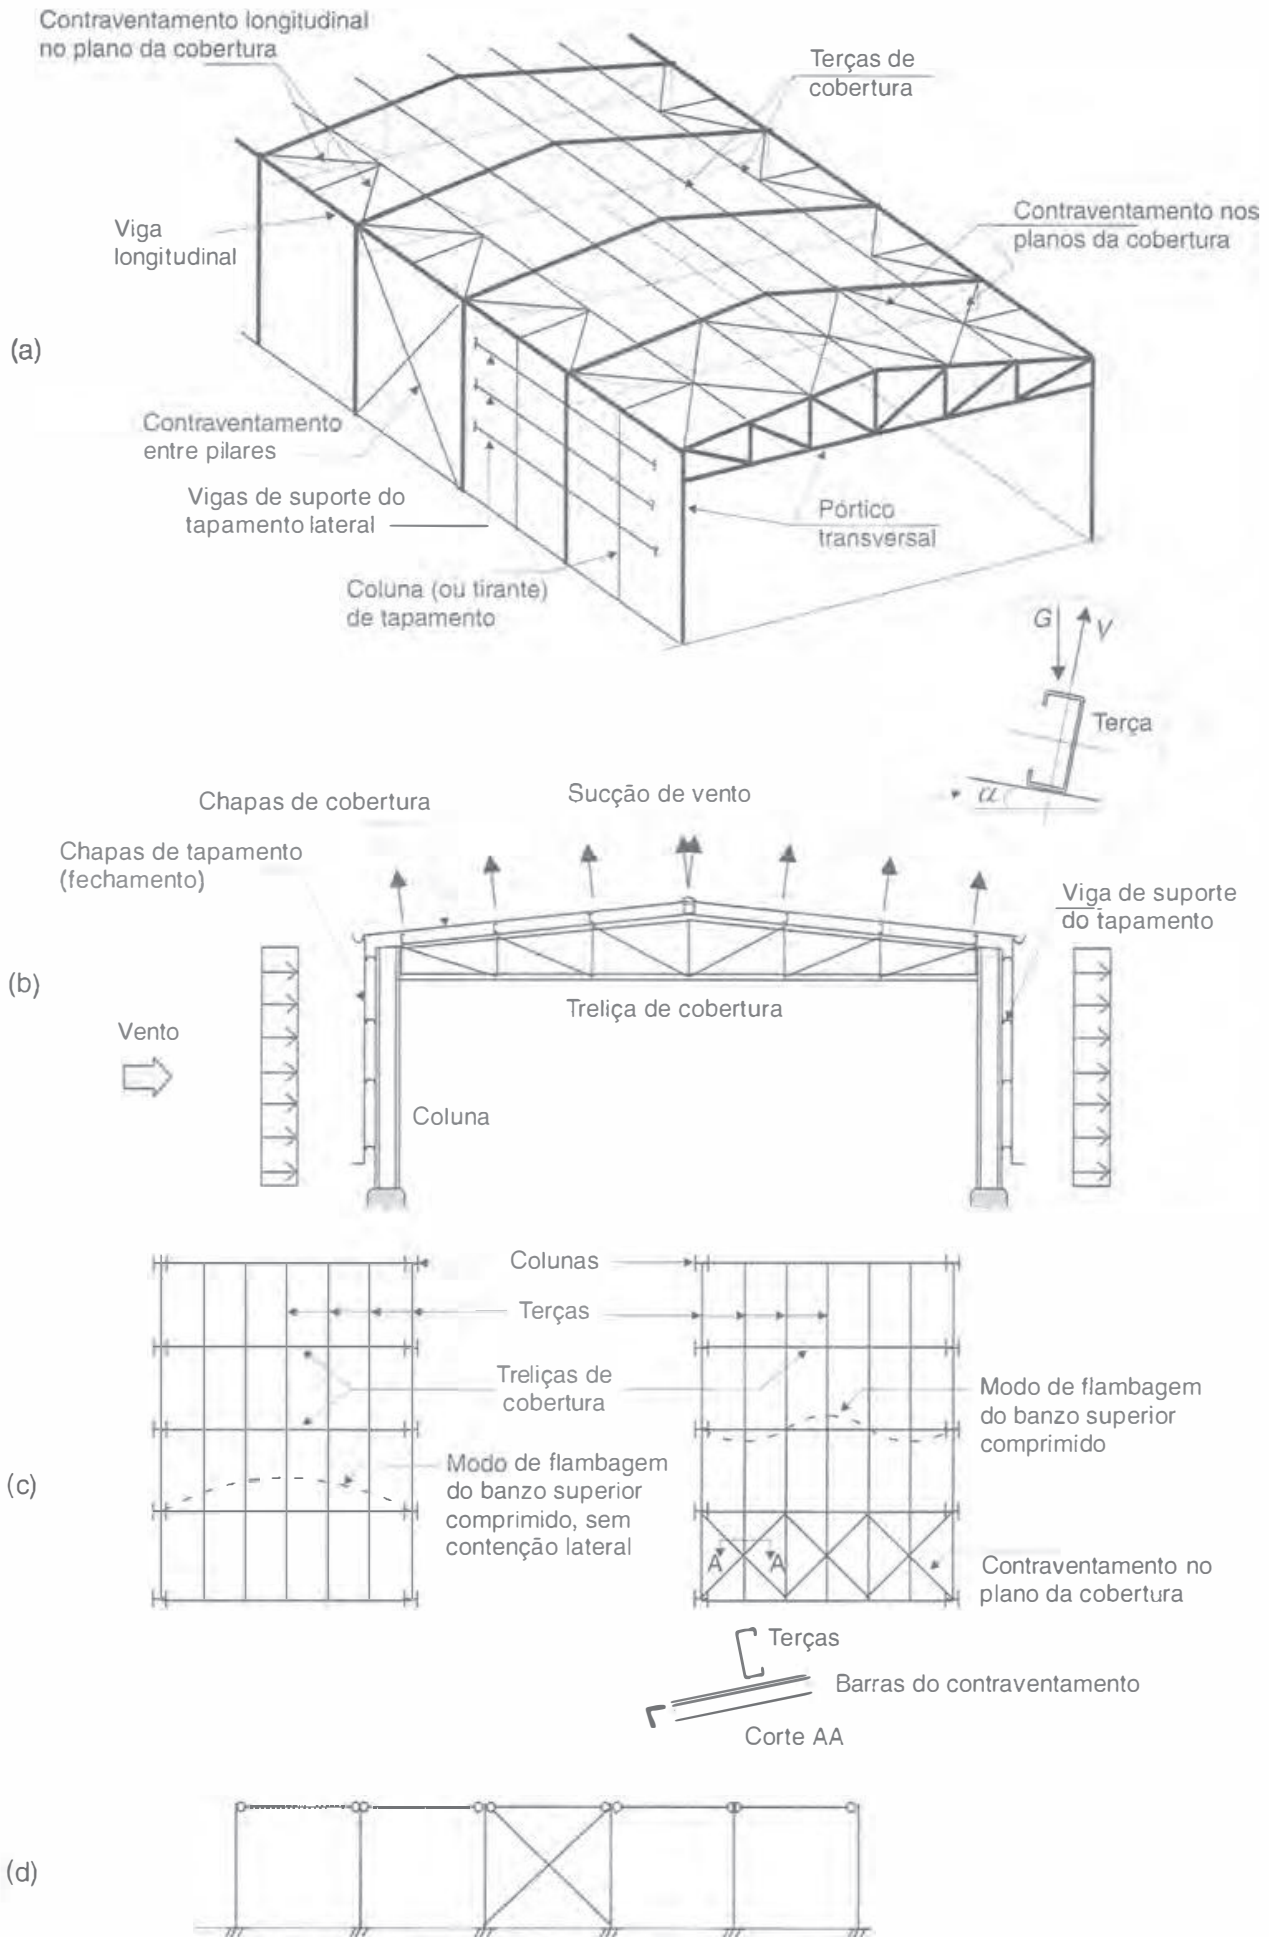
Galpão metálico: (a) esquema tridimensional; (b) pórtico transversal sob ação do vento. No detalhe, terça sob flexão oblíqua; (c) planta da cobertura sem e com contraventamento; (d) vista longitudinal mostrando o contraventamento entre pilares.
